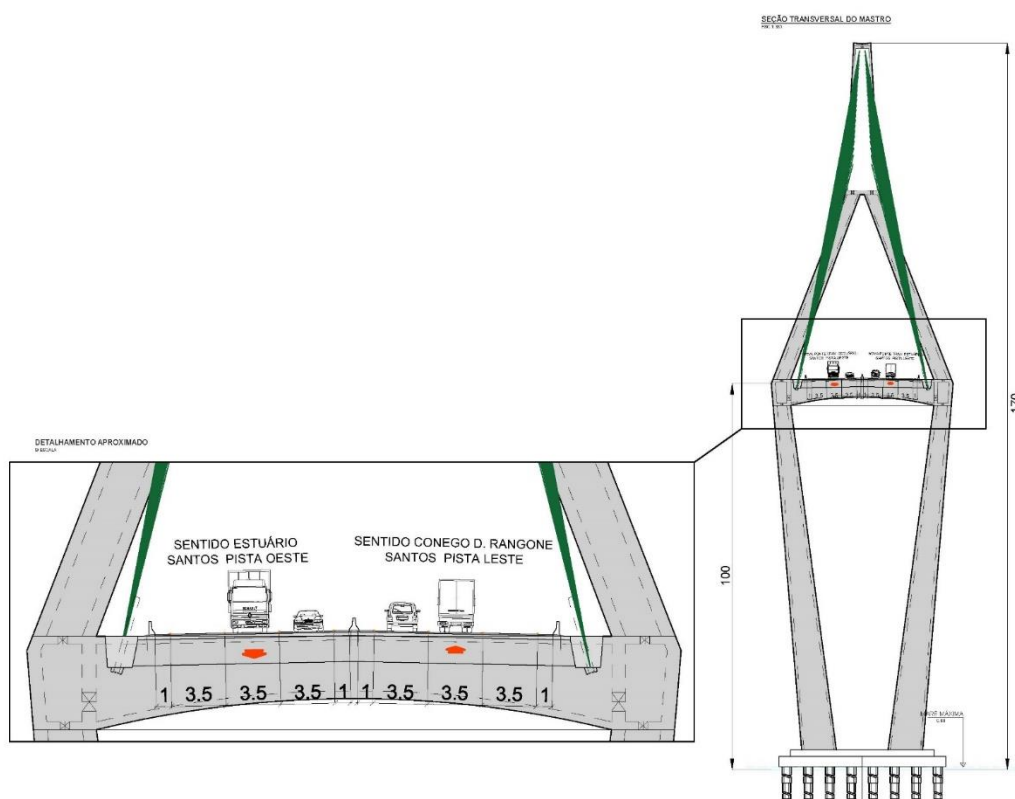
Balanço sucessivo, vista frontal.
